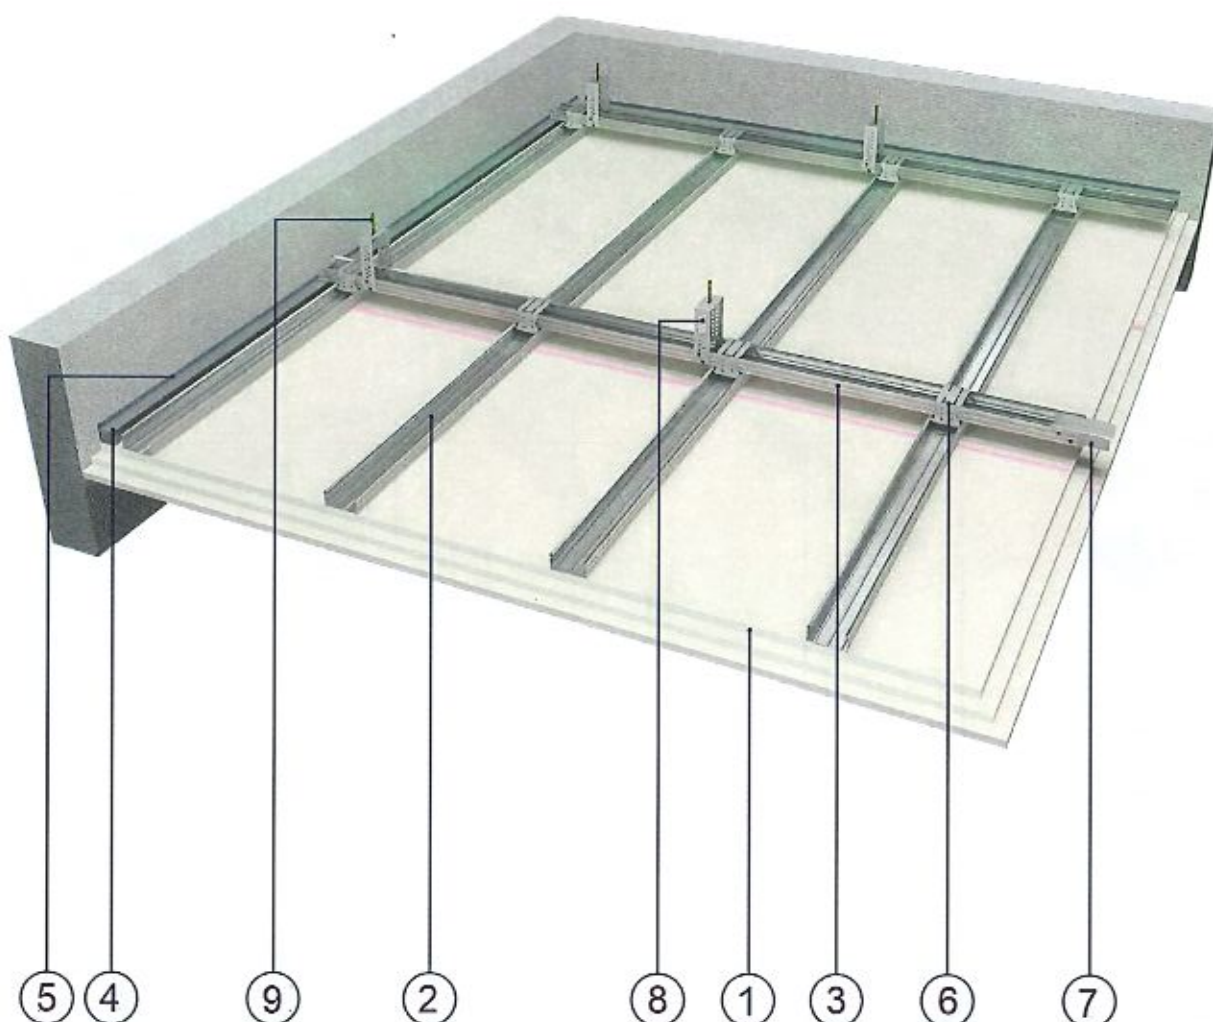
Widok sufitu podwieszanego – konstrukcja krzyżowa dwupoziomowa
